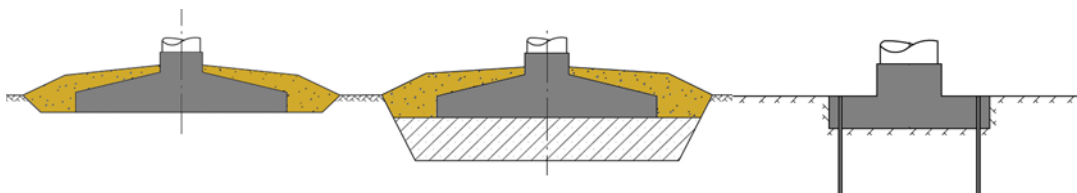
Vindkraftverk kan sättas upp på flera olika sätt. Modelleringar av armerad betongfundament på mark, armerad betongfundament med massutbyte och bergförankrade armerade betongfundament.
